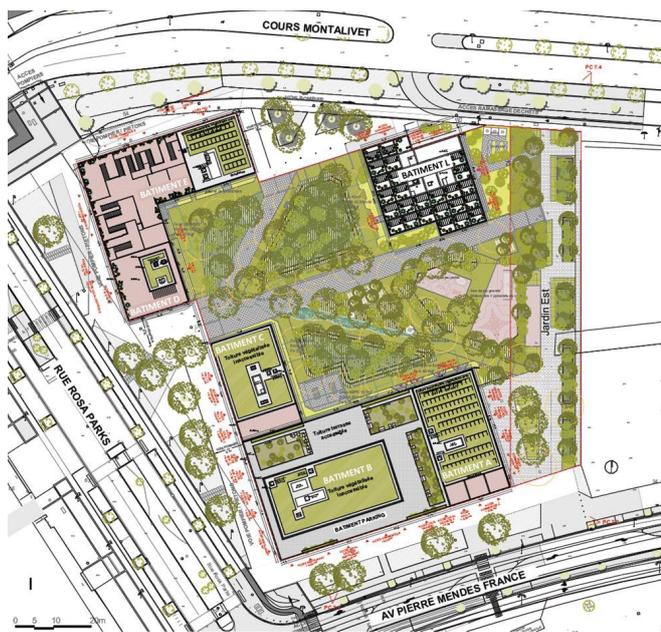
Plan de masse du projet (Source : p. 234 de l'EI).
